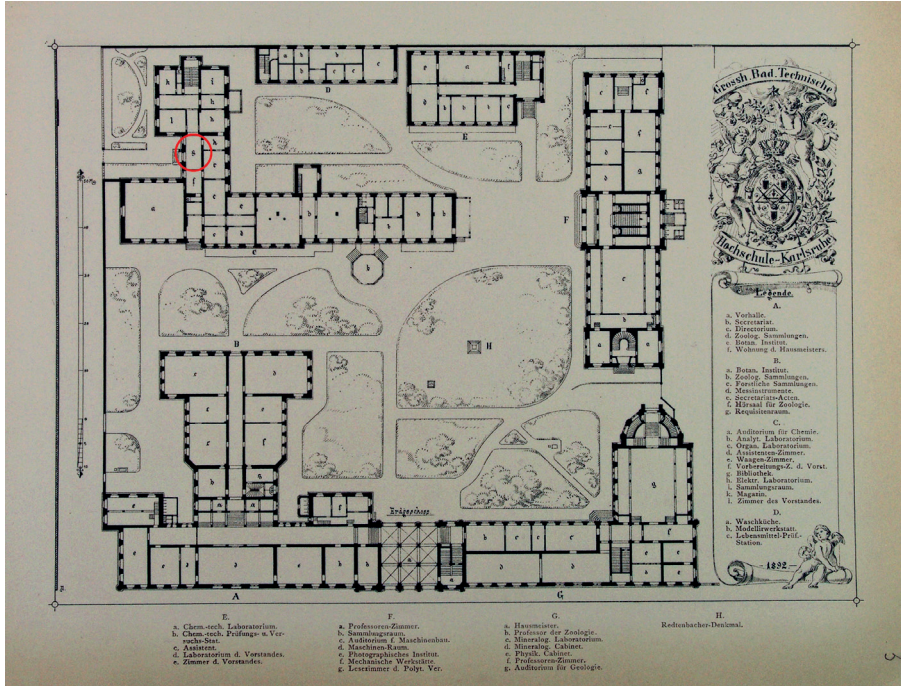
Grundriss des T-Baus 1892 (Bibliothek: vgl. Markierung)
